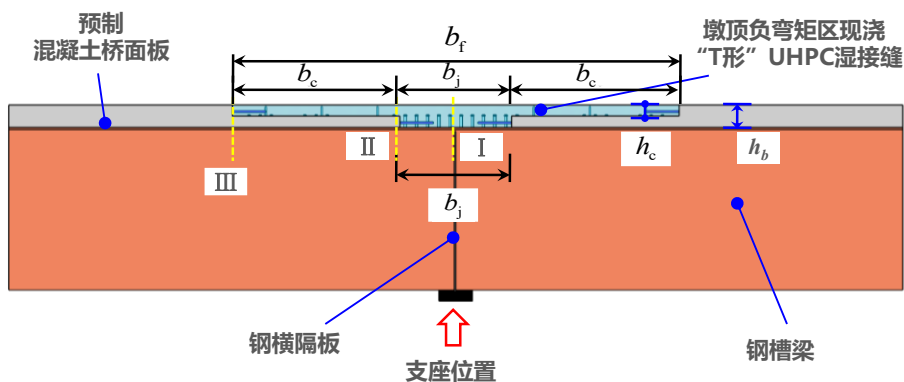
钢-混凝土组合小箱梁横向湿接缝方案
